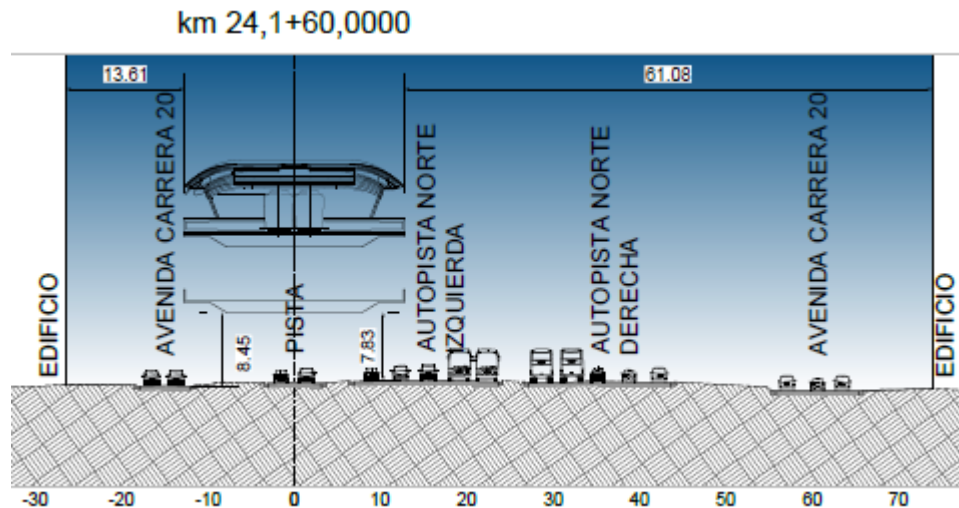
Sección transversal de nivel plataforma y mezzanina superior en PK 24+160
